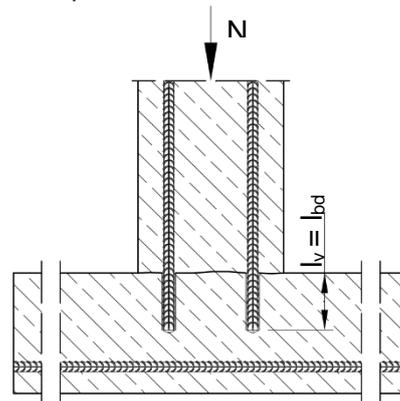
Übergreifungsstoß einer Stütze oder Wand an ein Fundament; Bewehrungsstäbe auf Zug beansprucht
